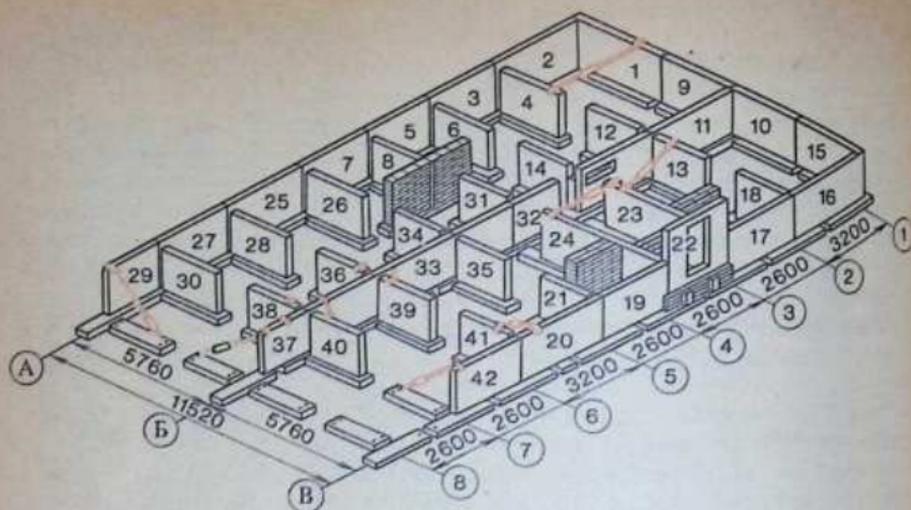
Последовательность монтажа технического подполья от жесткой леечки (указана цифрами)
